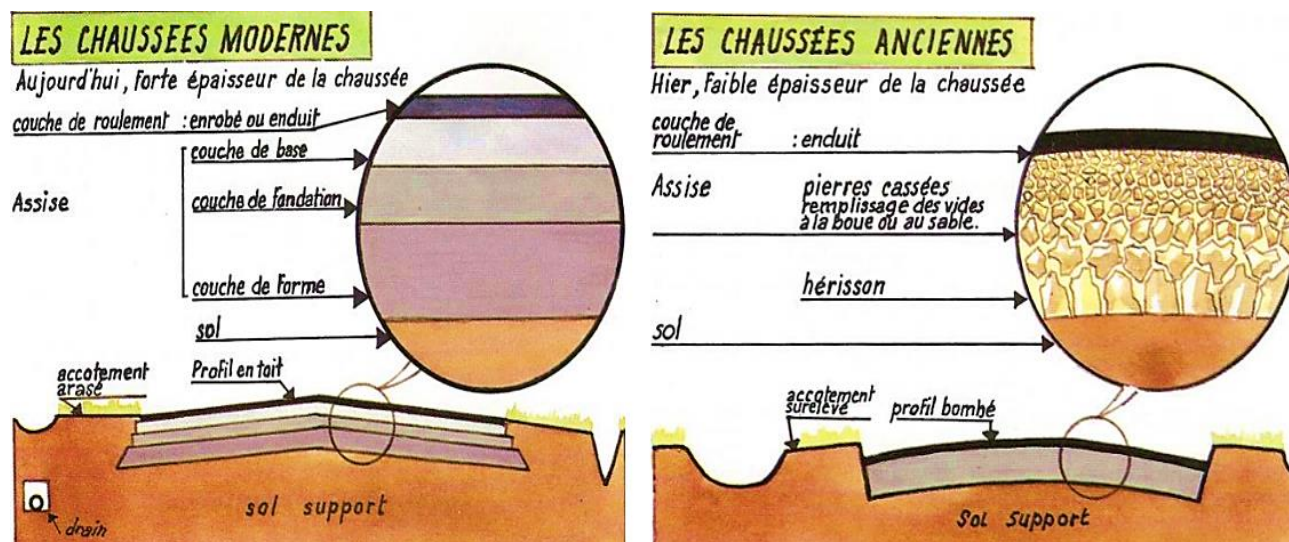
Schéma Structurelle d'une Chaussée Modernes et Ancienne.
